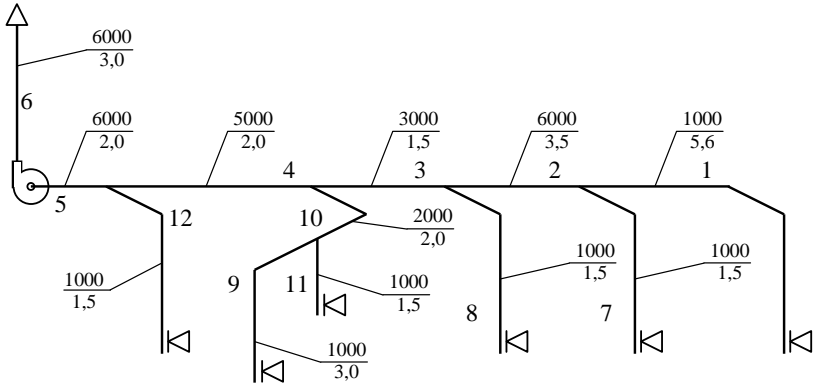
Аксонометрическая схема вытяжной вентиляционной системы
